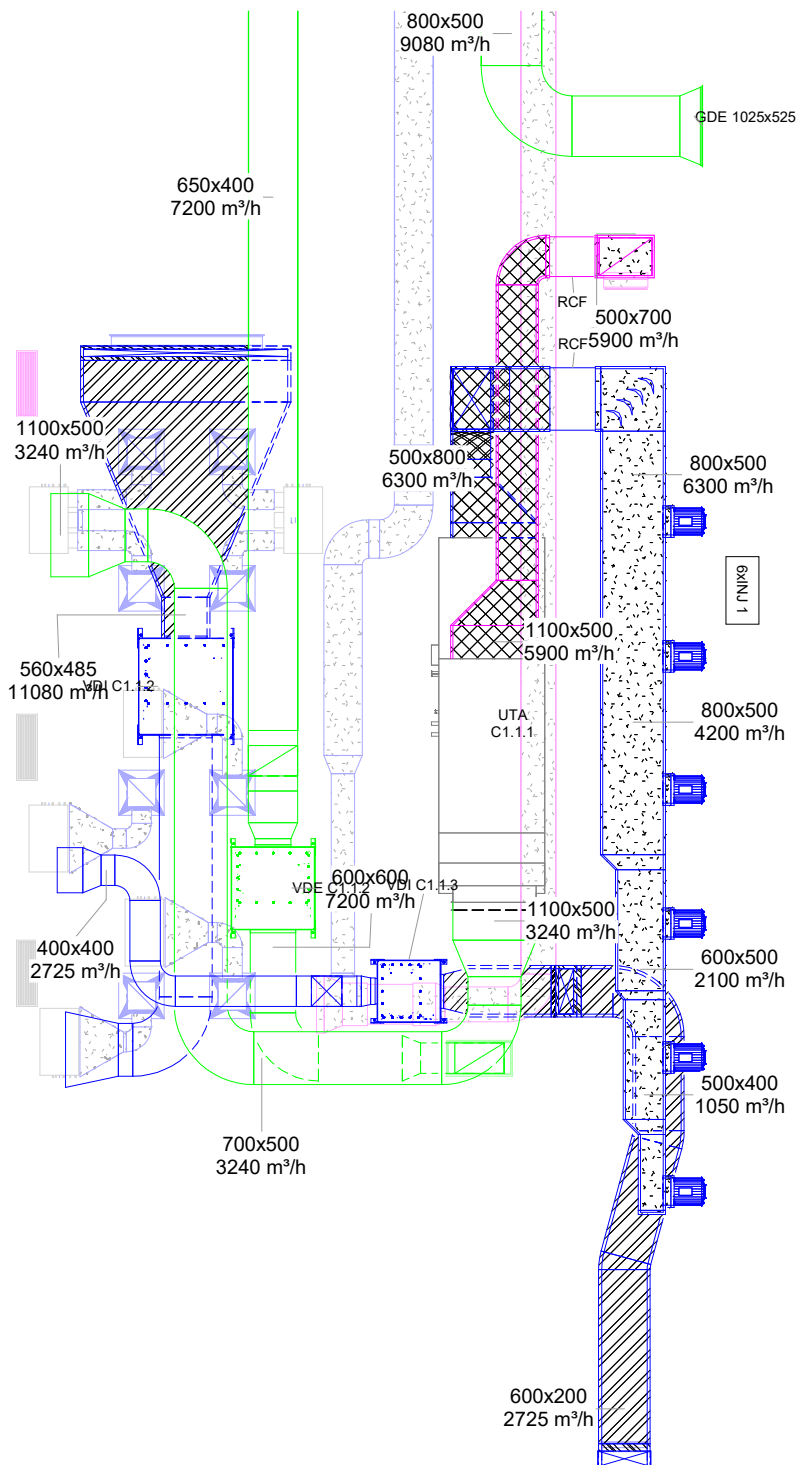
Seção 2.1 da planta geral do traçado das condutas na mezzanine à escala 1:100.
